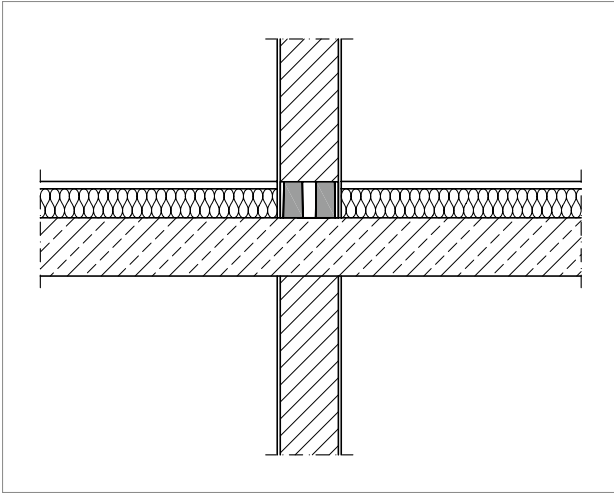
Darstellung einer Schnittzeichnung mit detailliertem Schöck Sconnex® Modell
